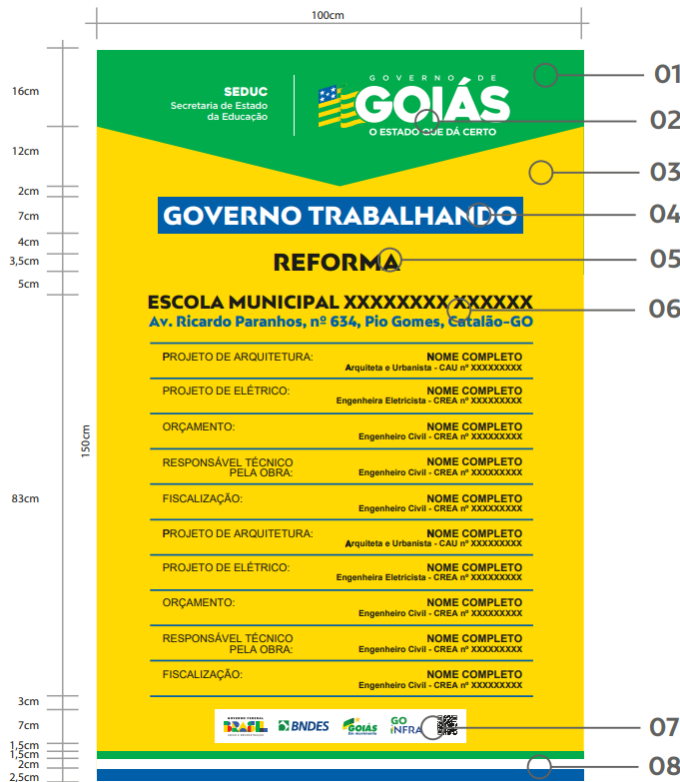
Placa de FISCALIZAÇÃO (fonte: GOINFRA-2023).
